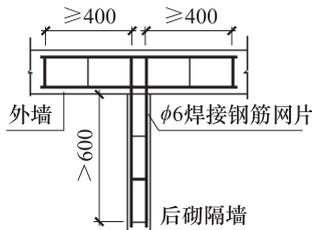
焊接钢筋网片（单位：mm）
